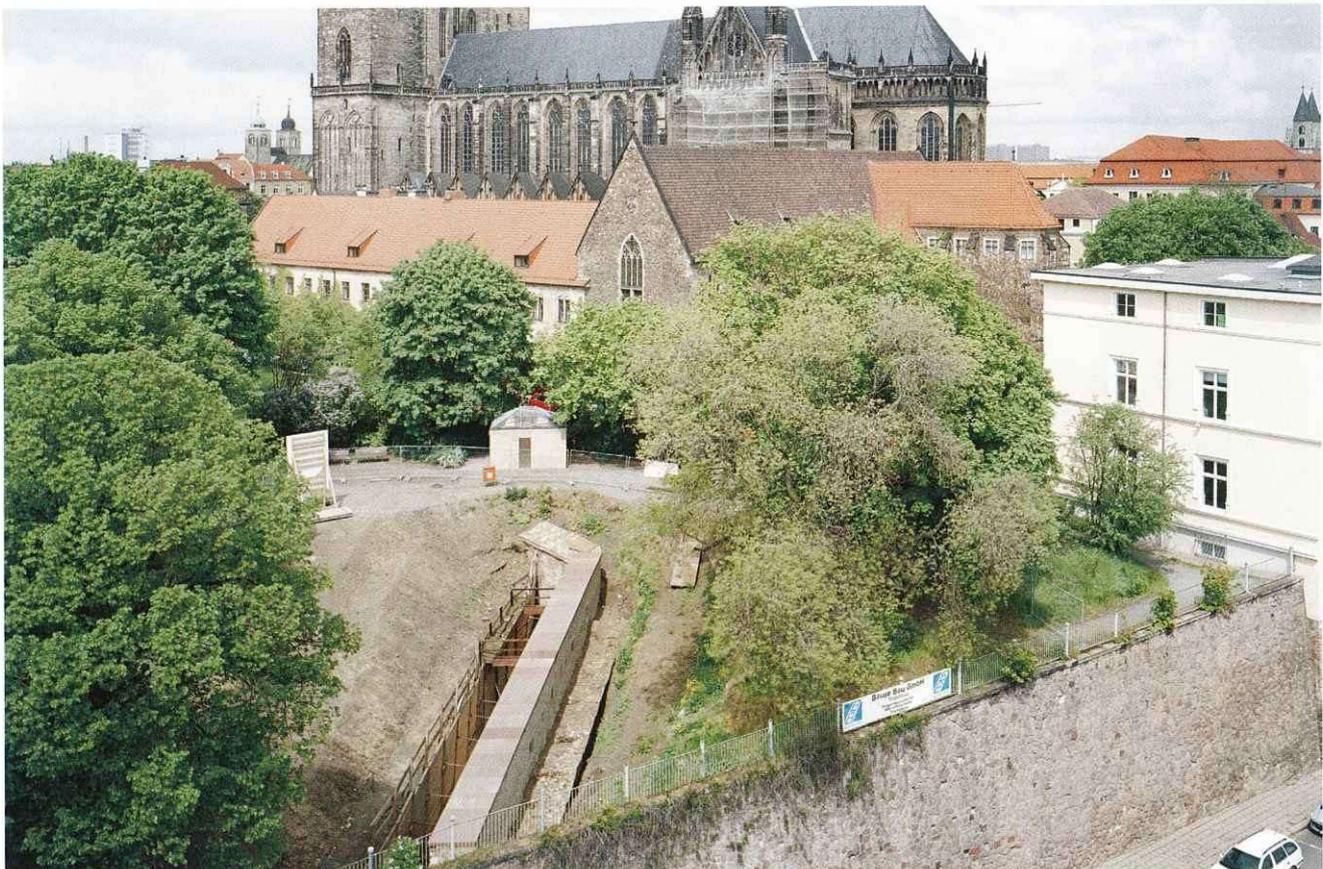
Park am Fürstenwall mit Blick nach Norden
